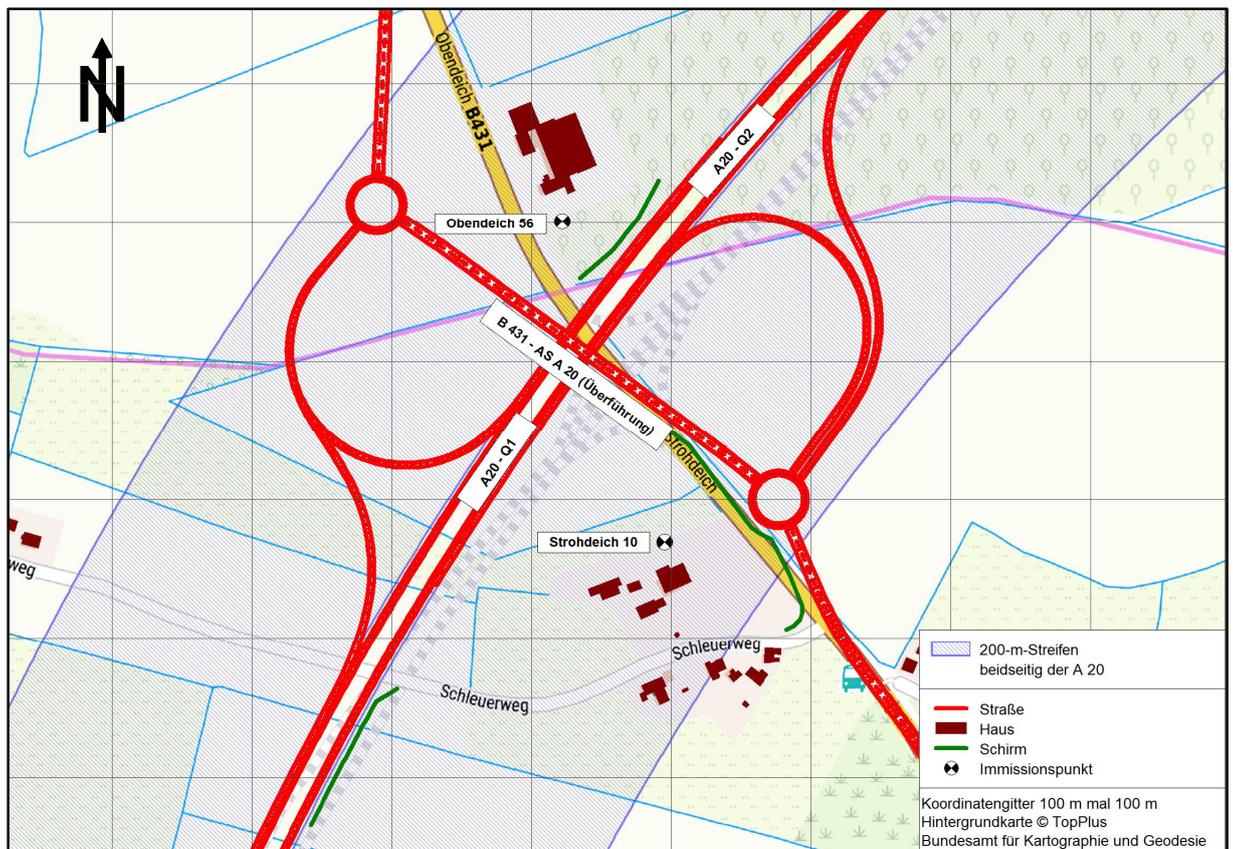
Lageplanskizze – Anschlussstelle Glückstadt
